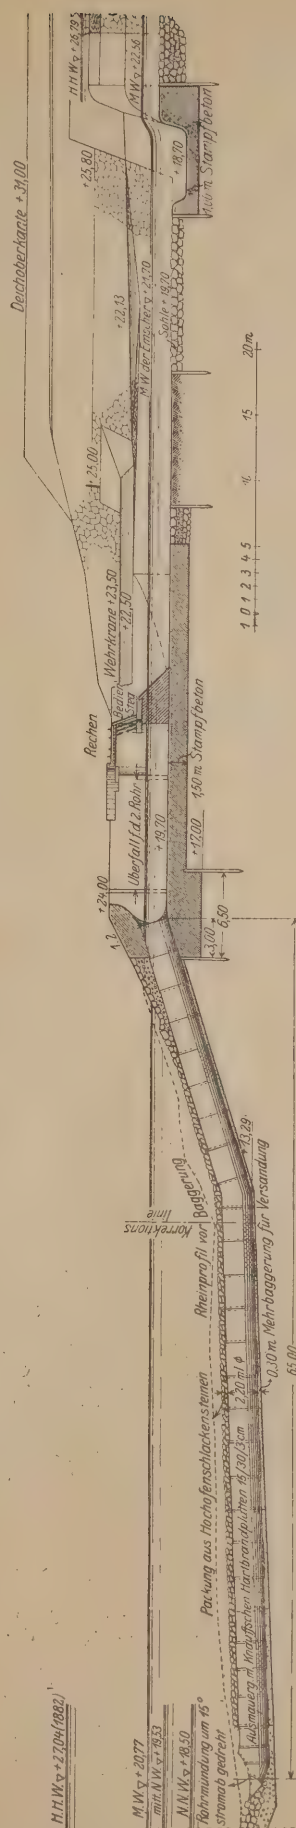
Längsschnitt durch das neue Einleitungsbauwerk.
